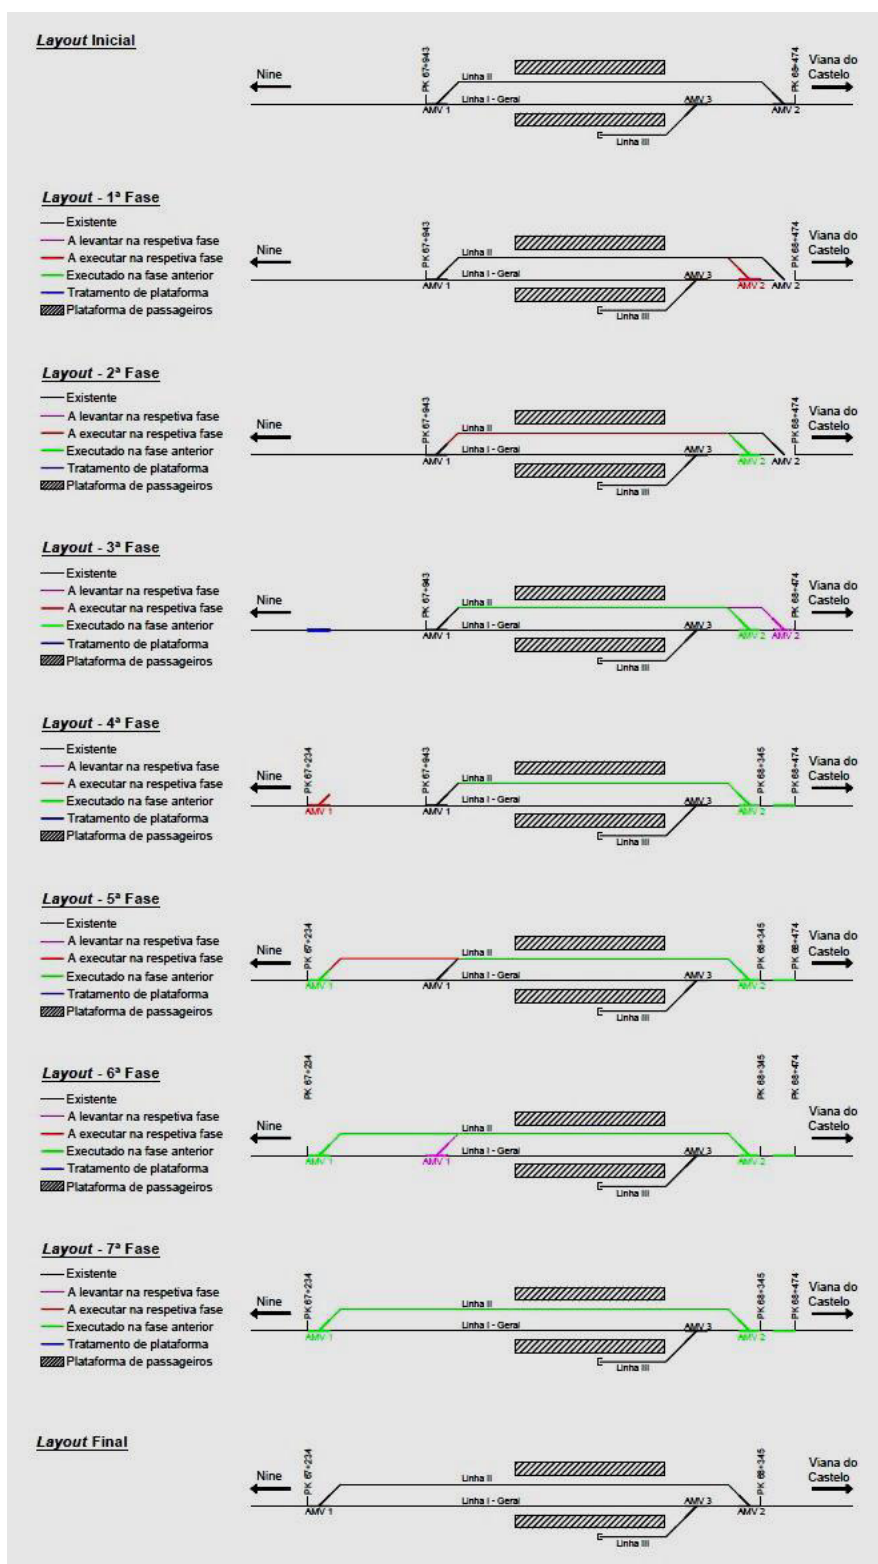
Faseamento construtivo da estação técnica de Barroelas
